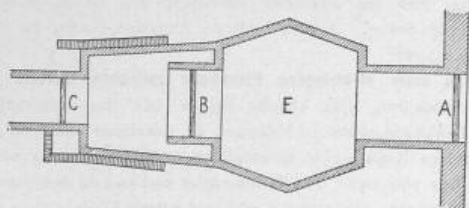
Grundriss vom Einlauf des Emissars des Fuciner-Sees. (Schematisch.)
